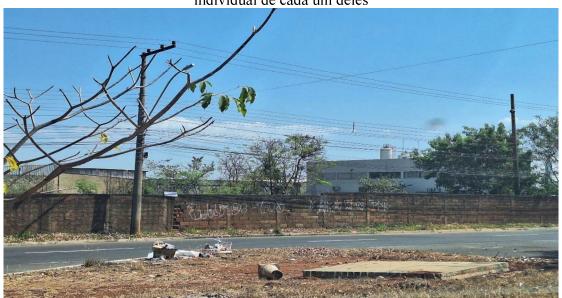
lotes vizinhos 210/220 (empresa H2F)
